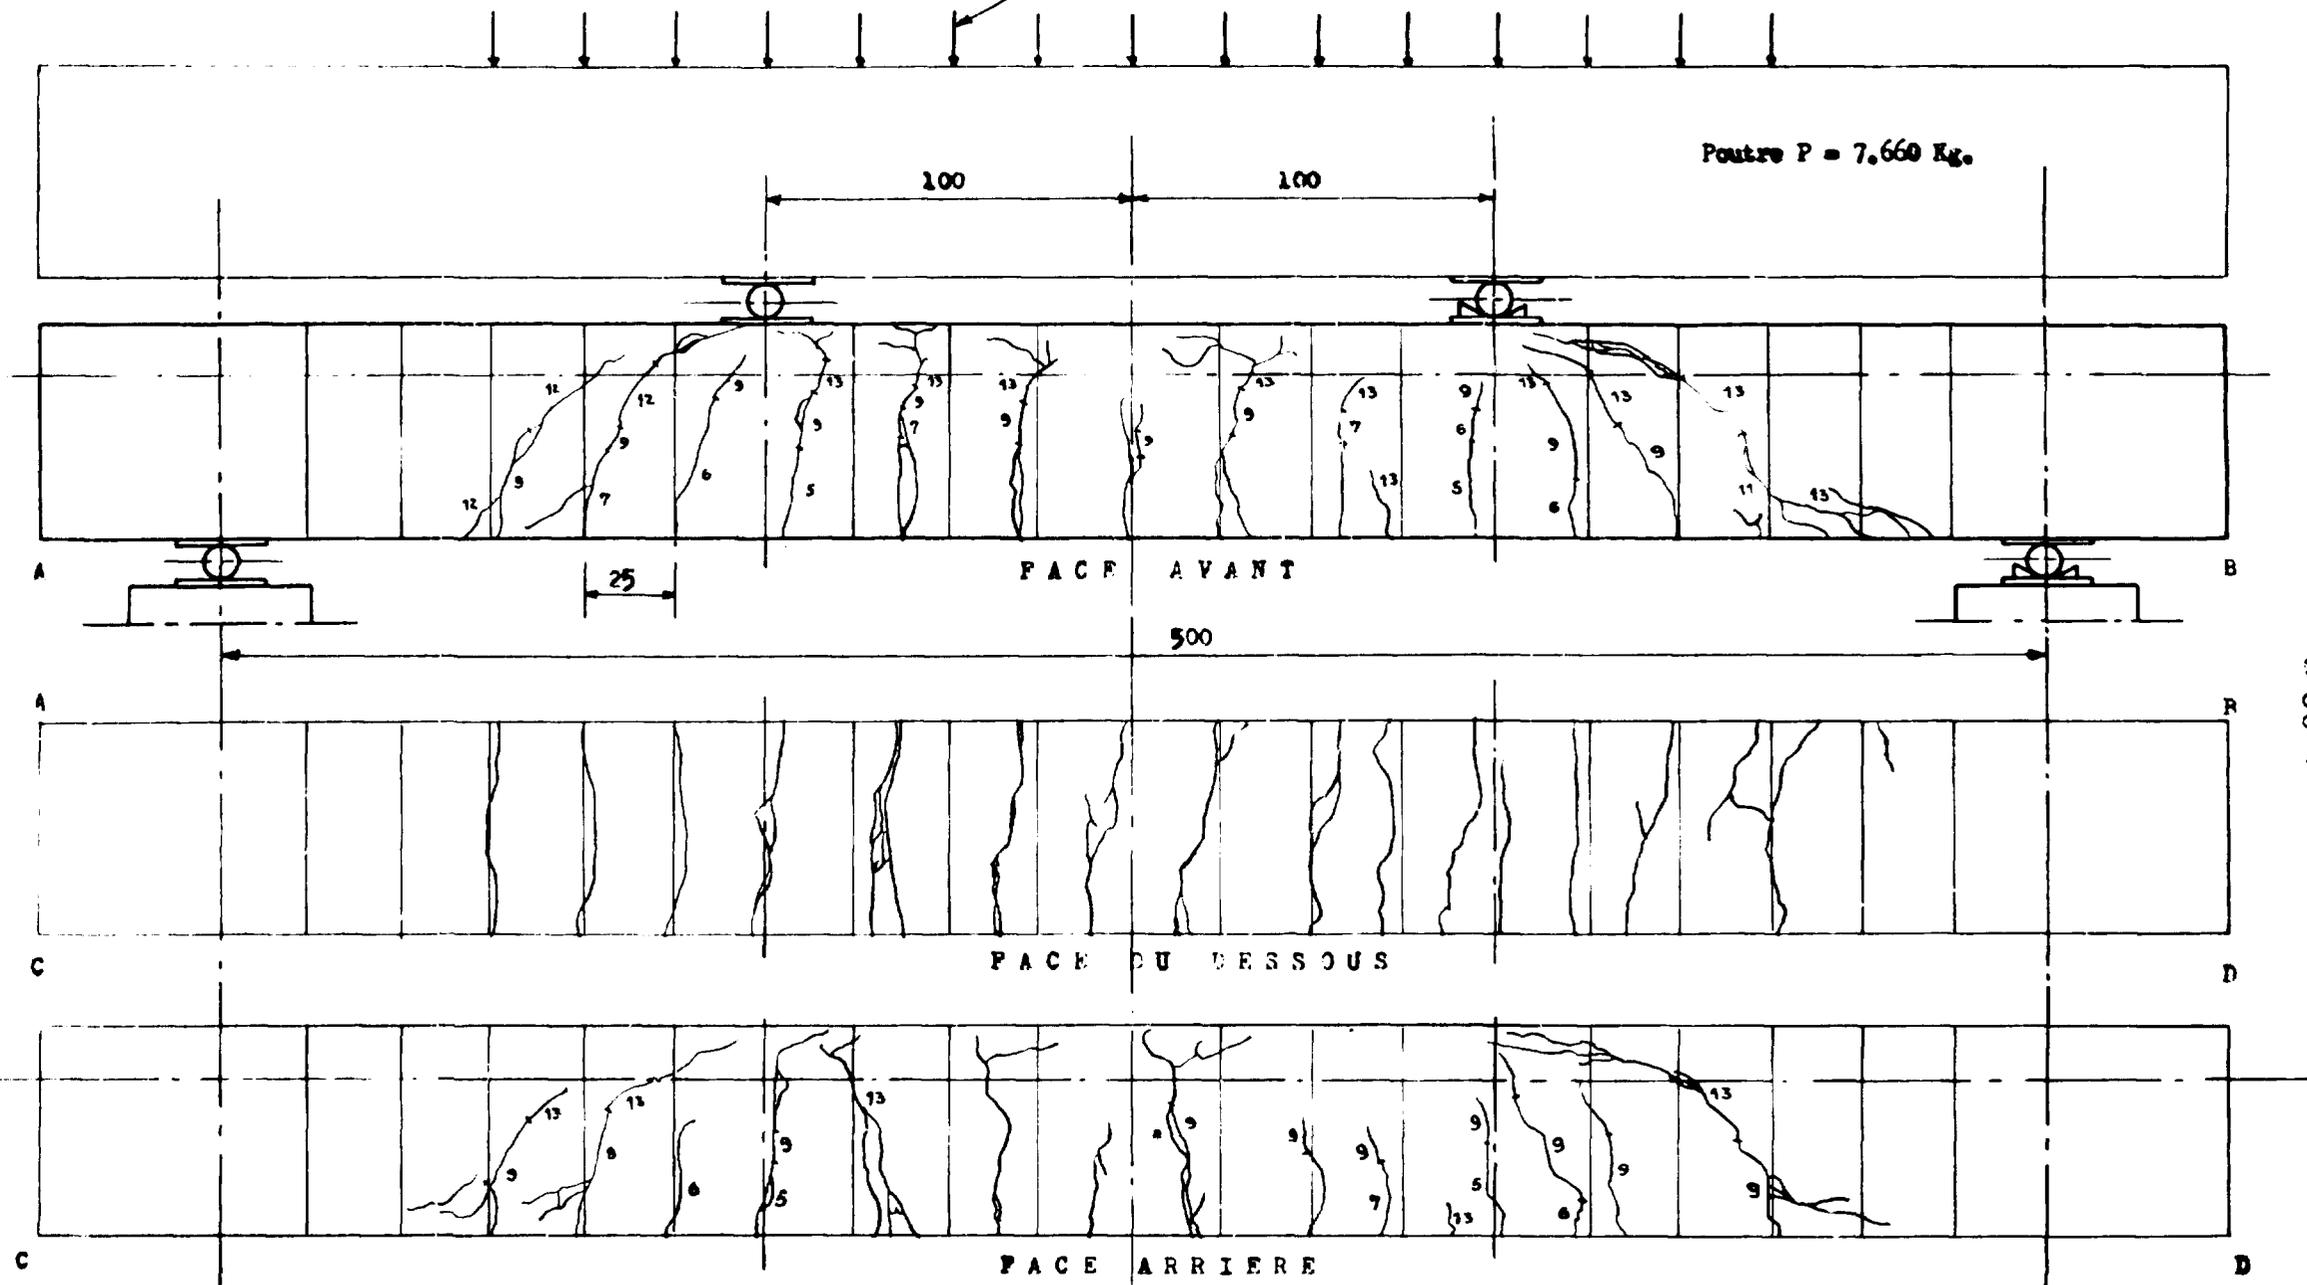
Relevé des Fissures de la Poutre en Béton de Barytine Armé (Charges Concentrées).
